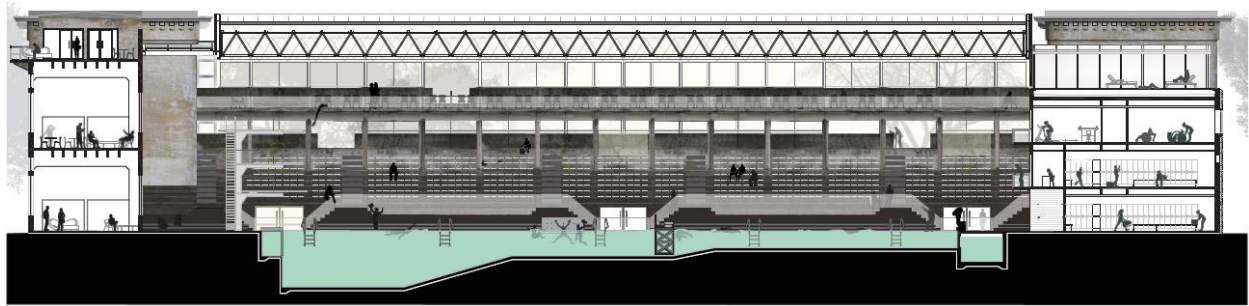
| Corte longitudinal por piscina olímpica | Vista hacia edificio existente
